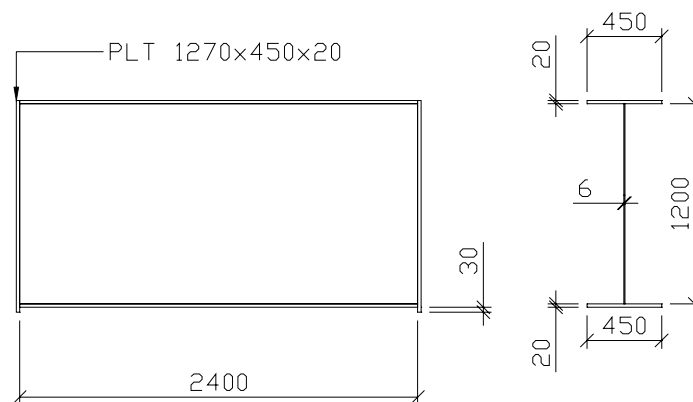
1. Alzados y detalles constructivos de la viga armada a ensayar [COMBRI, 2006a].
